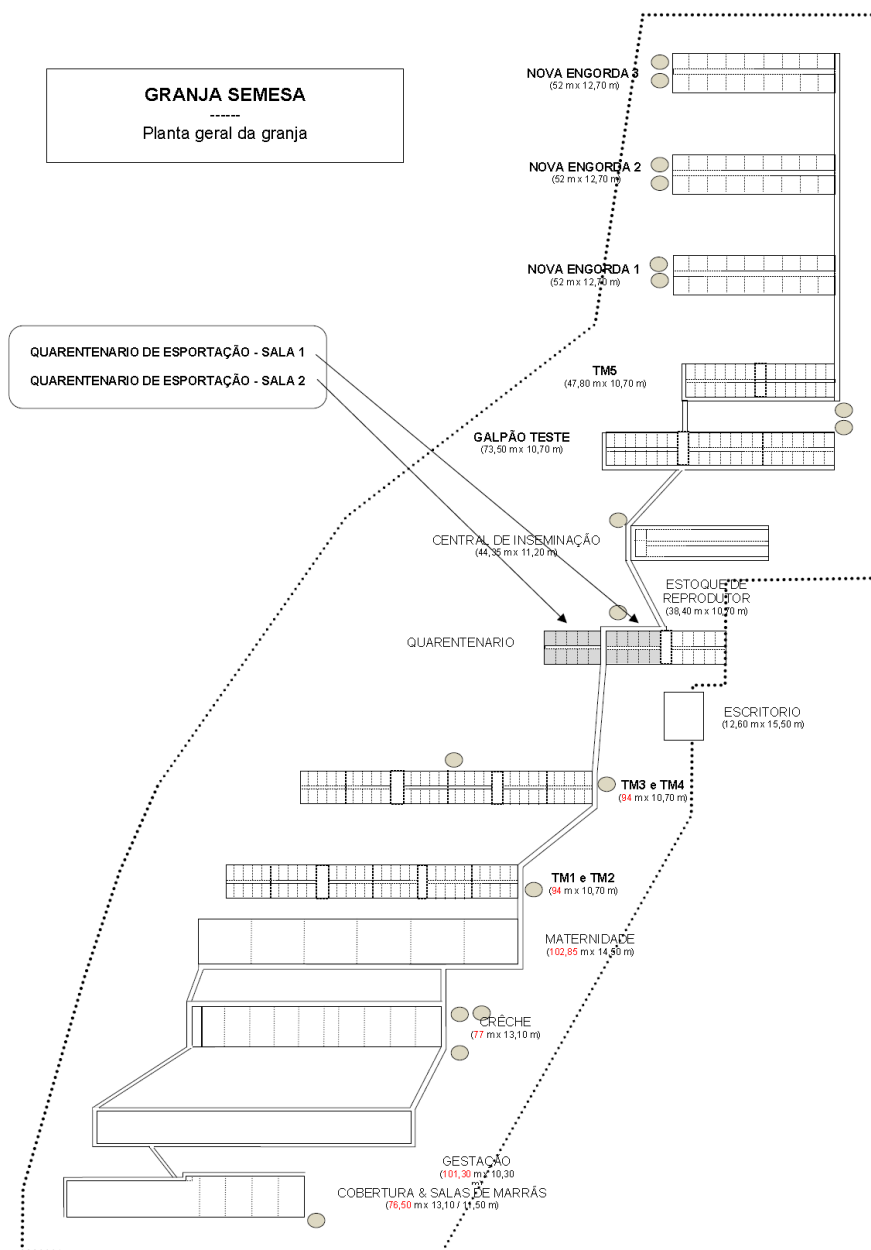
Planta da granja Semesa 2018. Fonte: POP's Granja Semesa.
